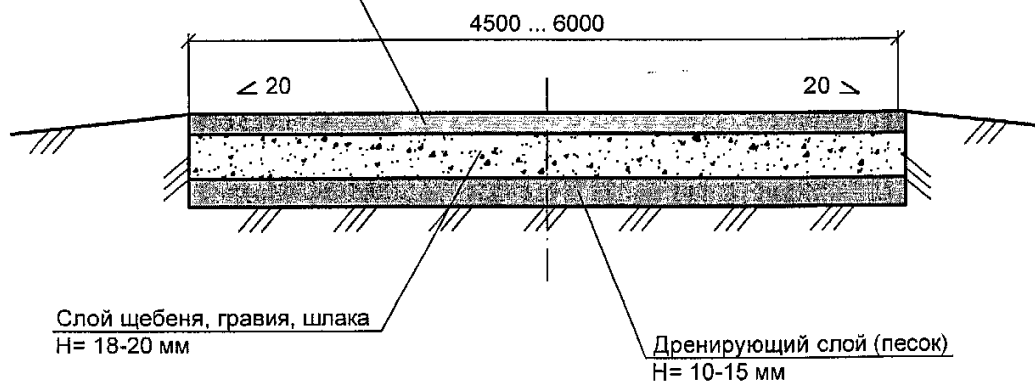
Конструкция временной дороги с асфальтобетонным покрытием
